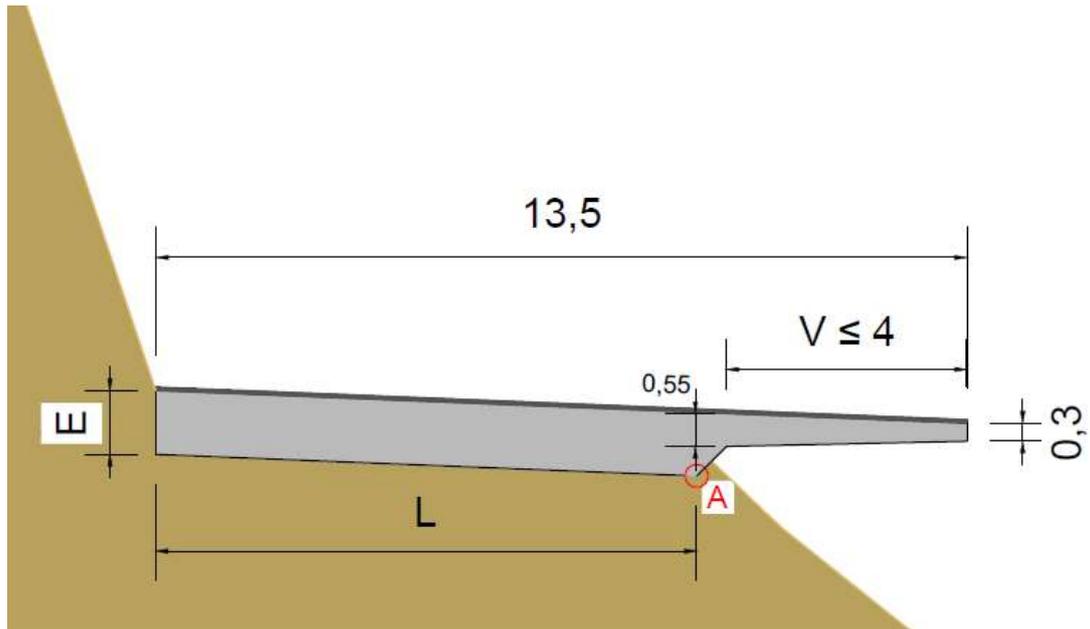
Voladizo con vuelo menor de 4 metros (cotas en metros)
